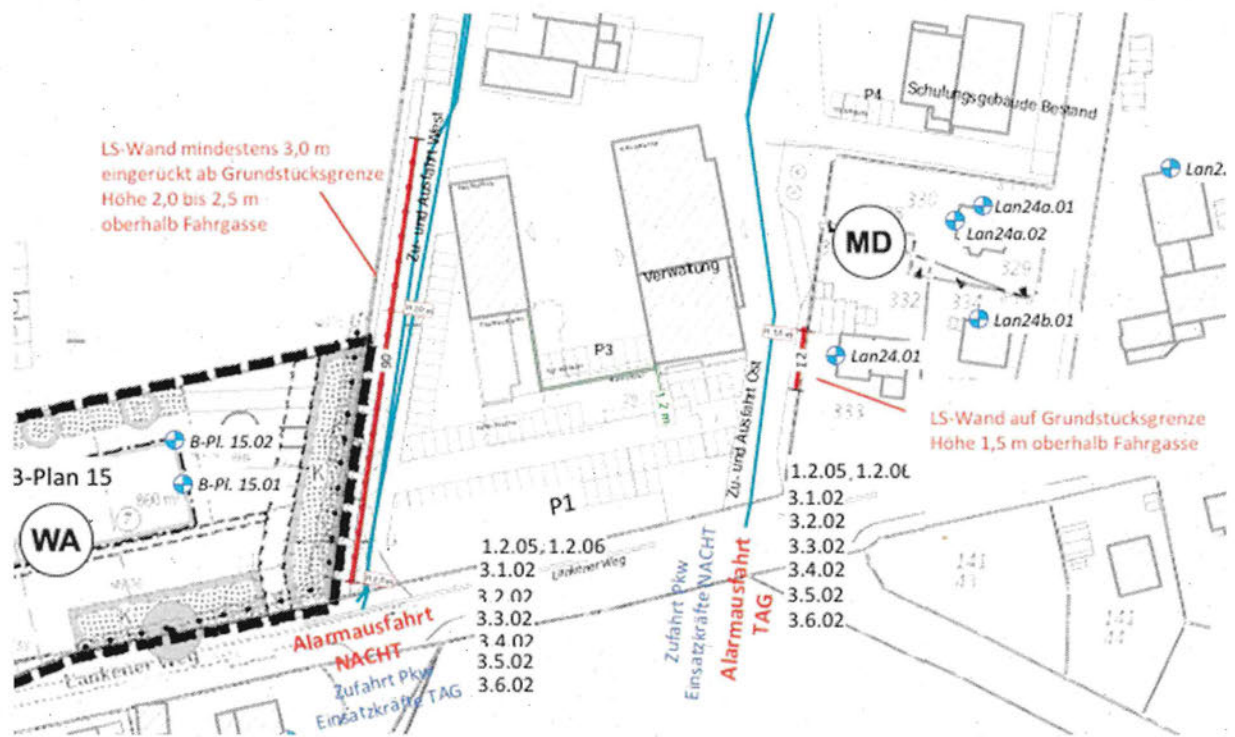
Planfall 3b - Sonderbetrieb LZ-G mit Lärmschutzmaßnahmen Variante 2
